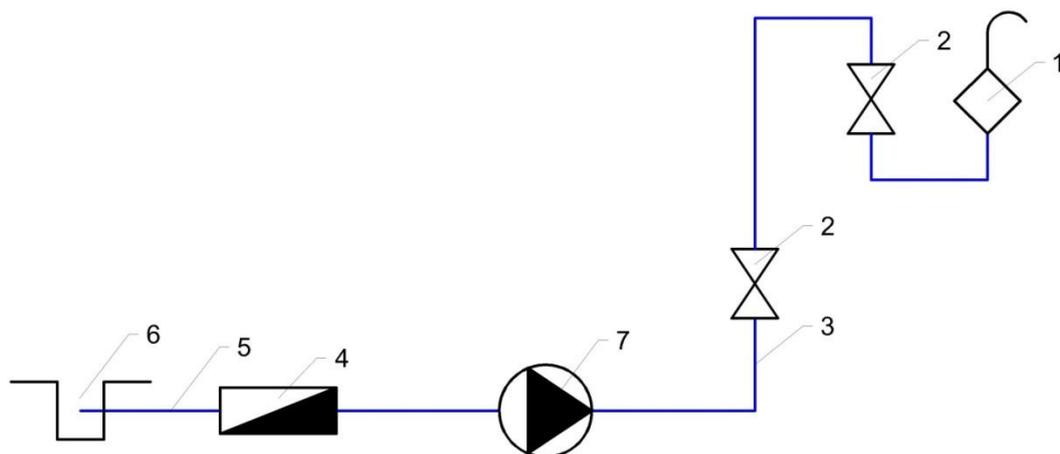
Схема внутреннего водоснабжения с нижней разводкой.
